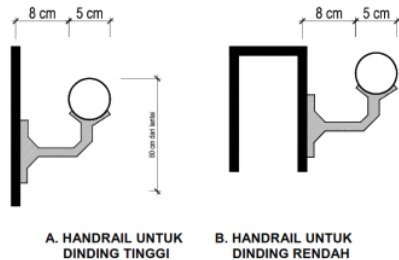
Desain Handrail Ramp untuk Disabilitas Tuna Daksa
